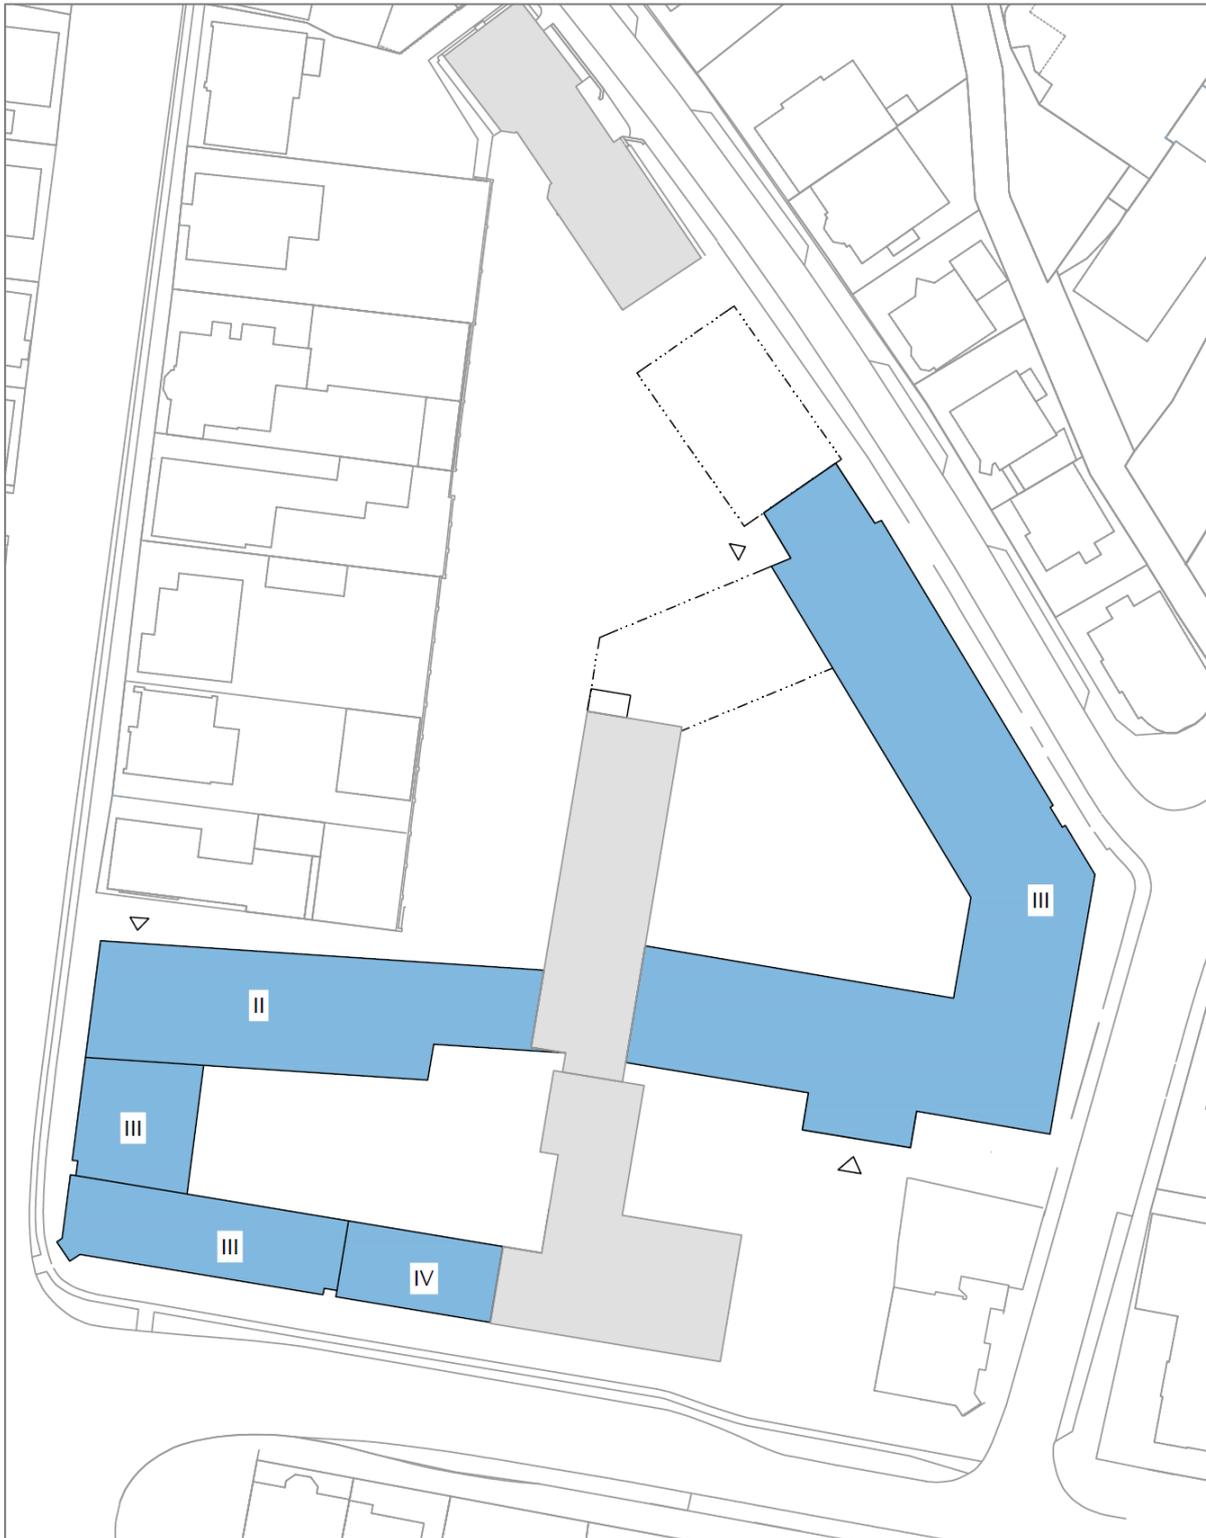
Dachaufsicht städtebauliche Leitidee
